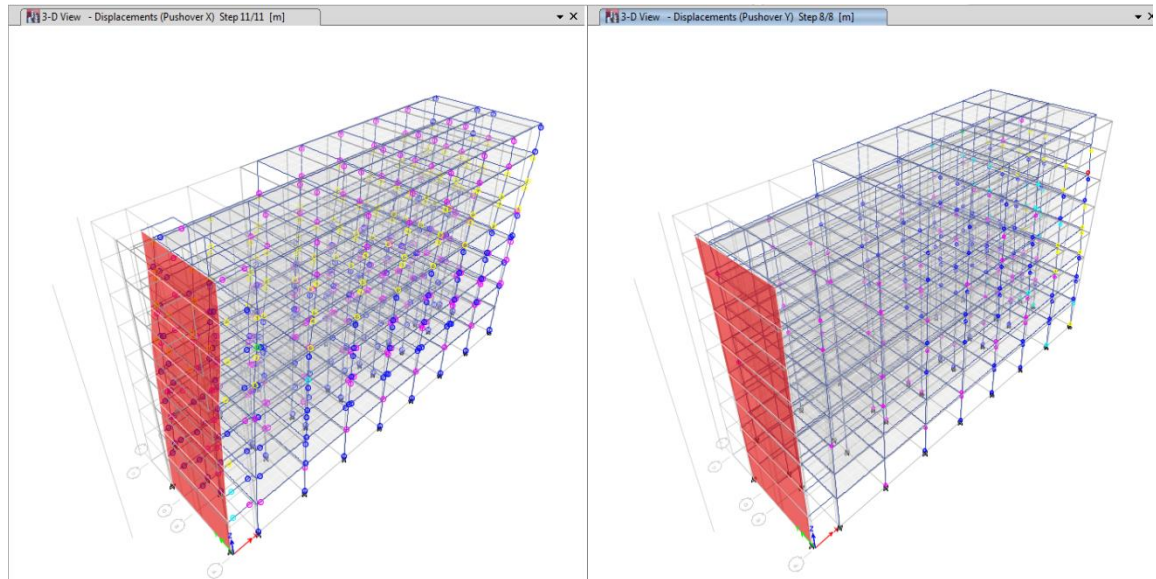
Formación de rótulas en vigas y columnas del bloque 1 (dirección X e Y)
